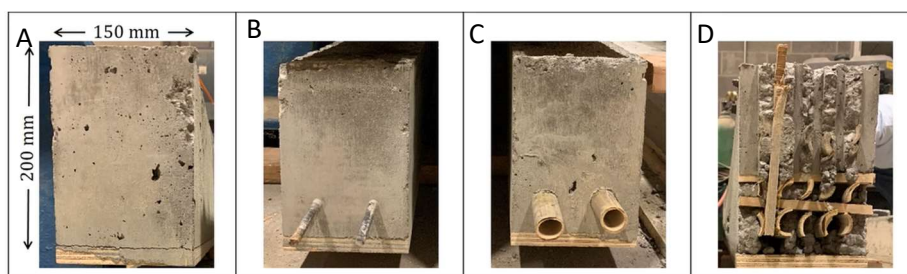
Příklad „armovacího koše“ z bambusu u základových pasů
